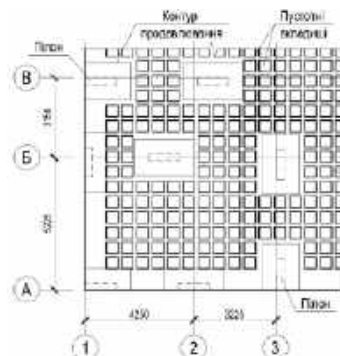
Фрагмент схеми розміщення пустоутворювачів в плиті перекриття.
